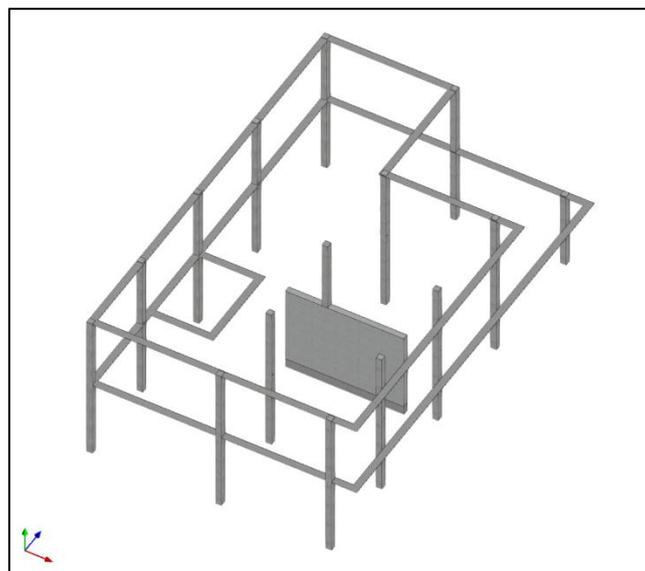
Recorte de pantalla, Vista 3D elementos verticales y vigas en Cypecad
